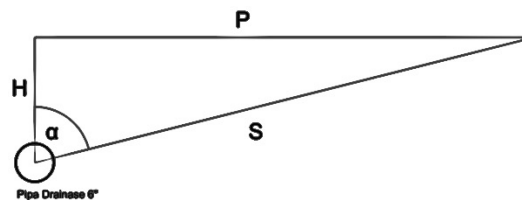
Denah Pipa Drainase di Lapangan Sepak Bola
